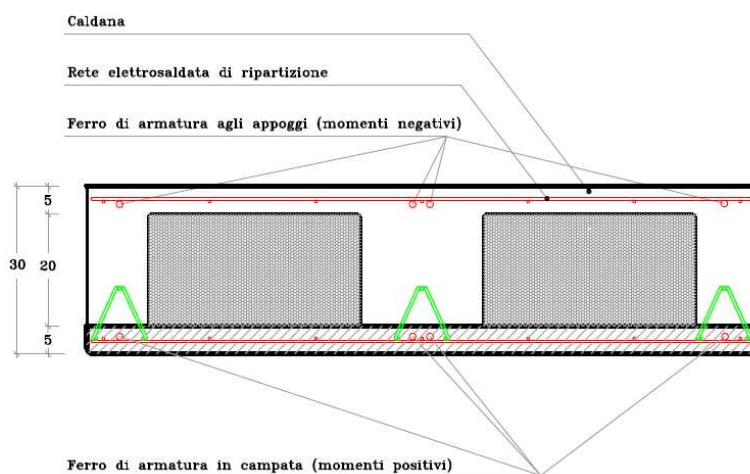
Sezione tipo di un modulo da 120cm di solaio predalles
